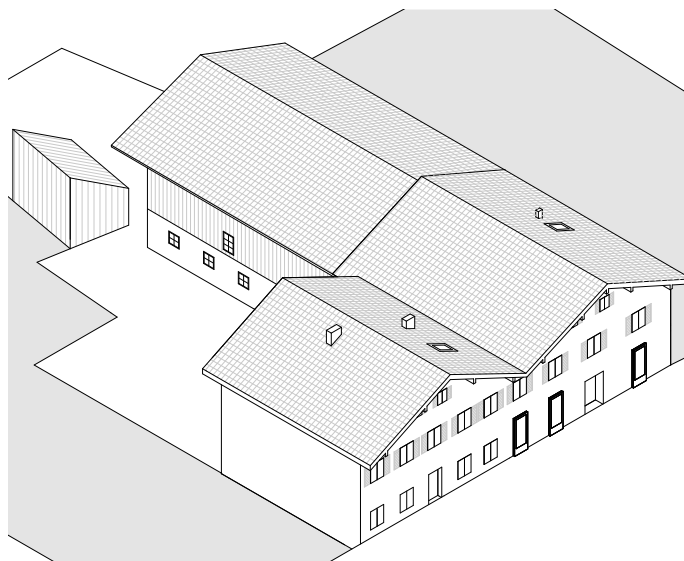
Isometr. Darstellung d. Bestandsgebäude 1946 | 1961 | 2015
